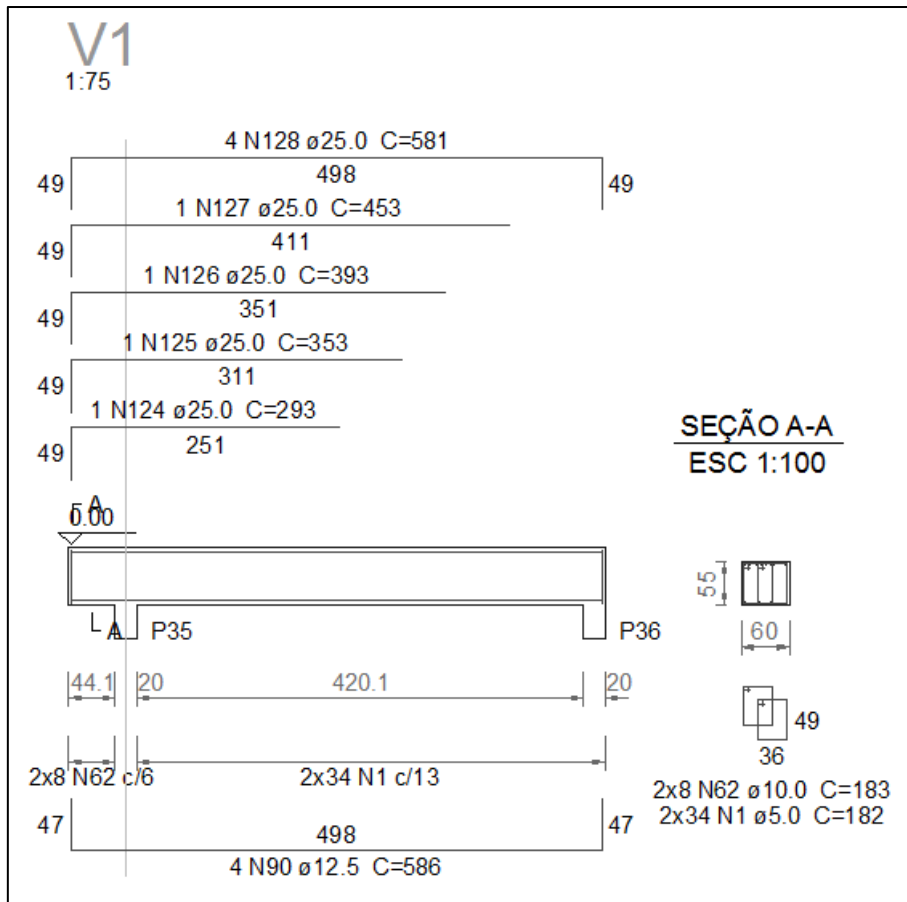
Detalhamento da Viga 1 dado pelo Eberik.
